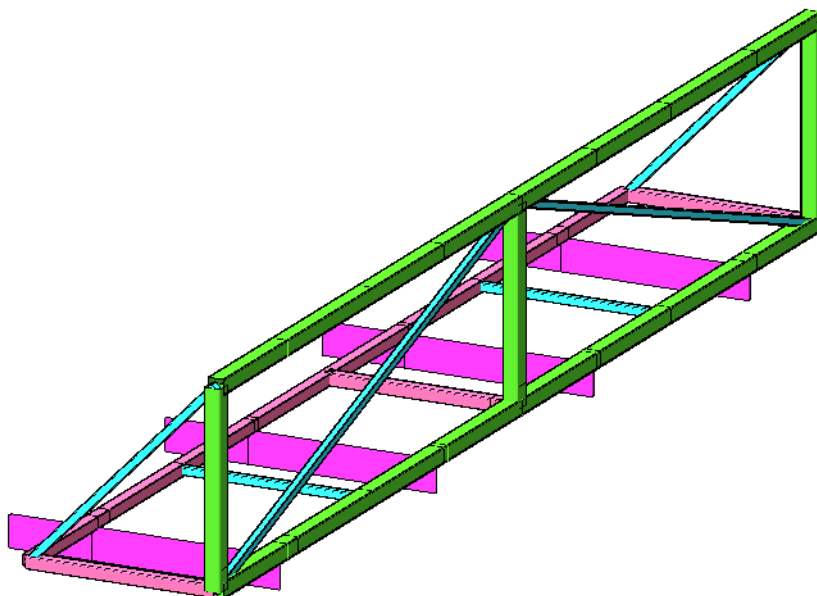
Объемный вид расчетной модели площадки для монтажа и обслуживания оборудования (конструкция)
